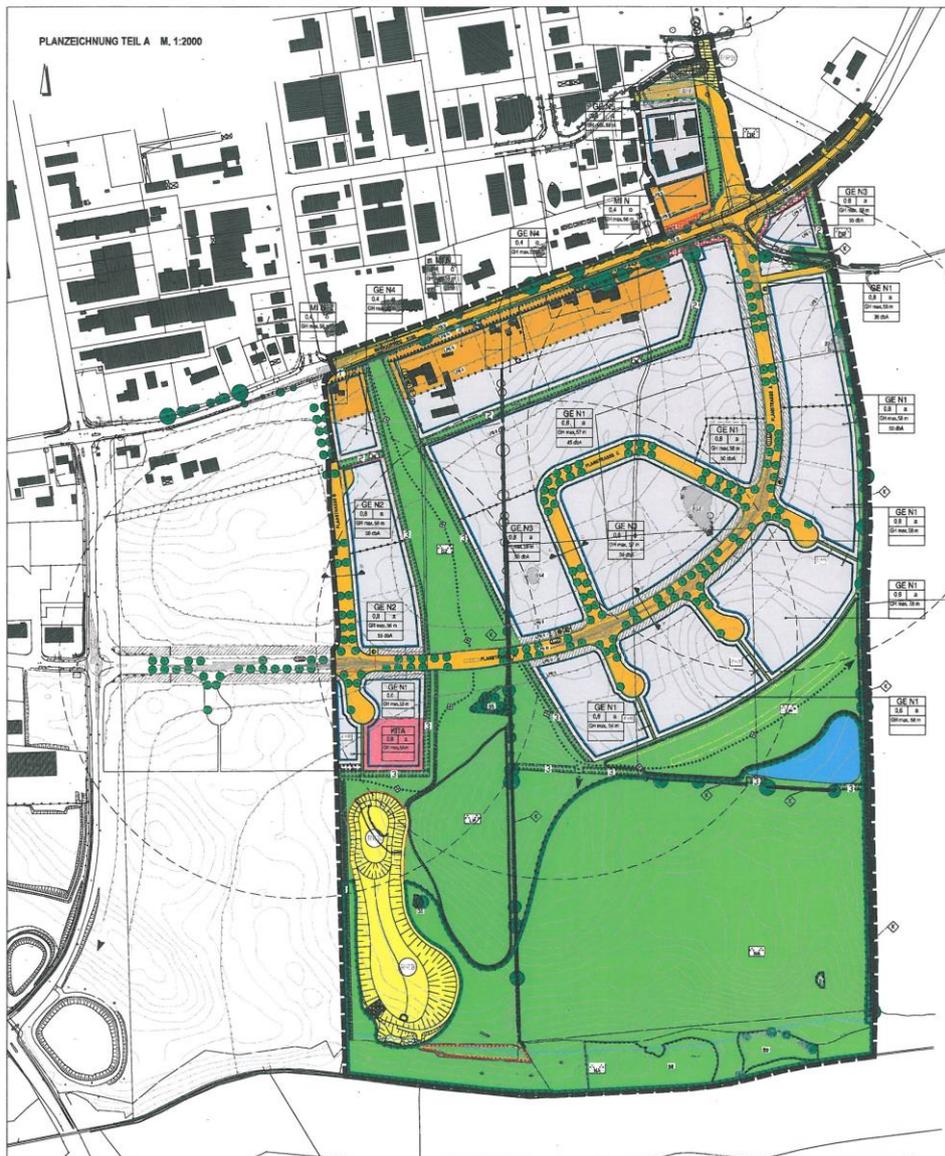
BPlan Nr. 88b (Entwurf der Stadt Ahrensburg; Stand: 12.05.2016)
